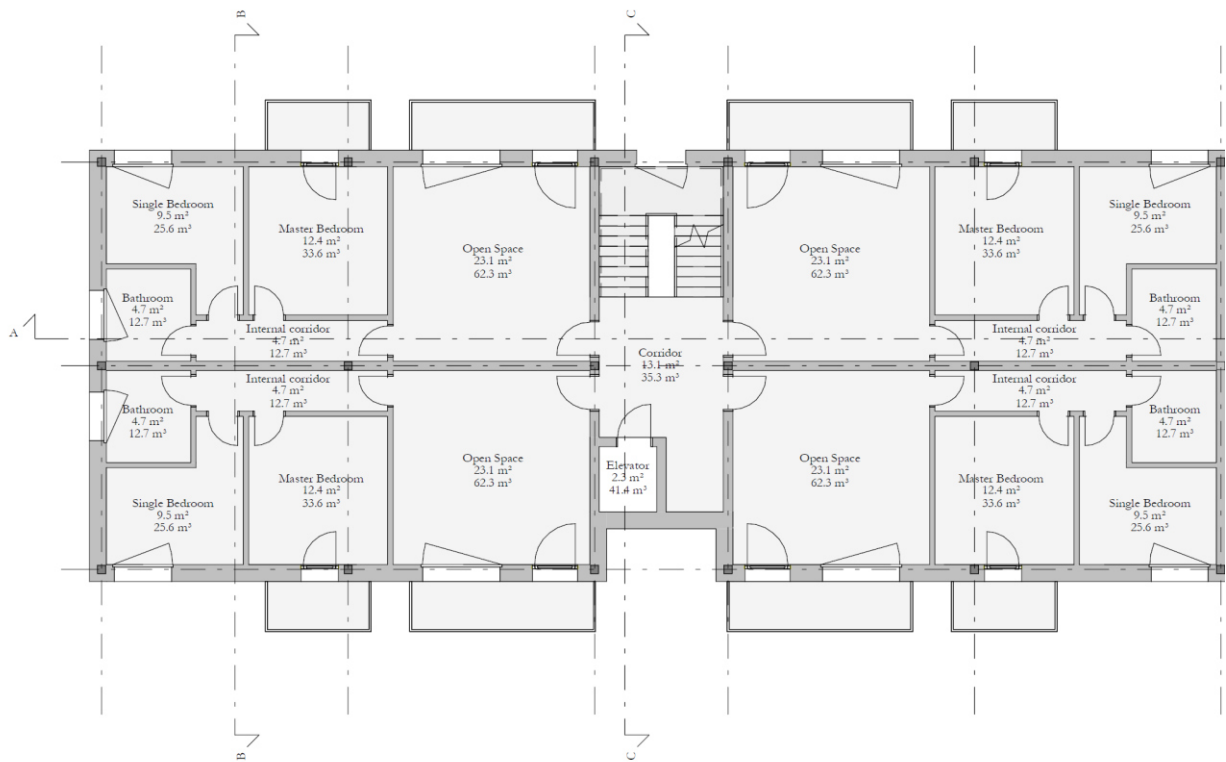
LRBo: pianta piano tipo, metà Ovest
